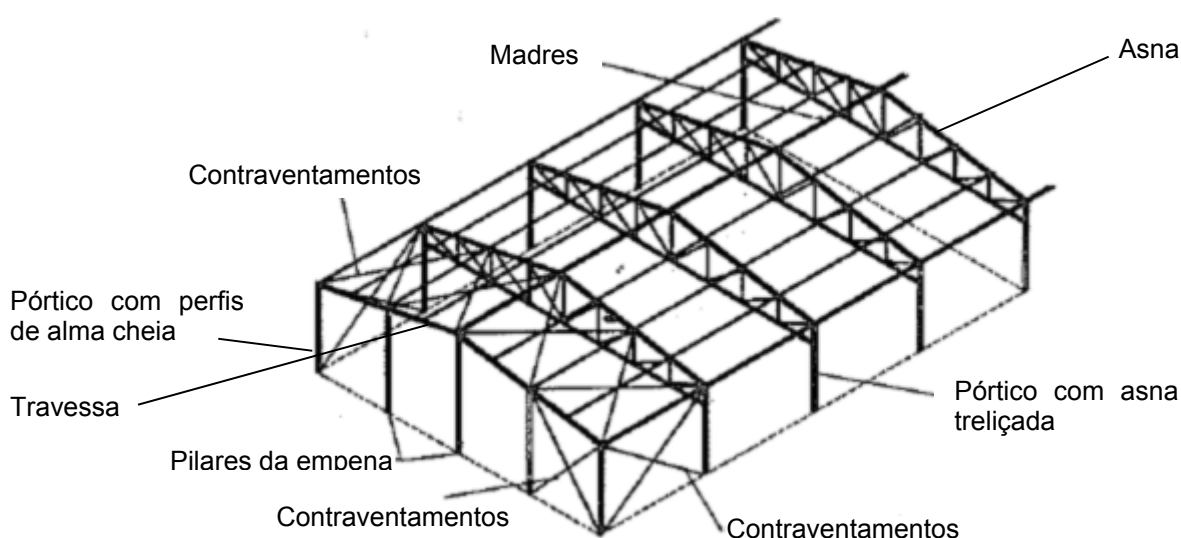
Elementos de uma estrutura metálica: adaptado (Alvarez, 2005)
